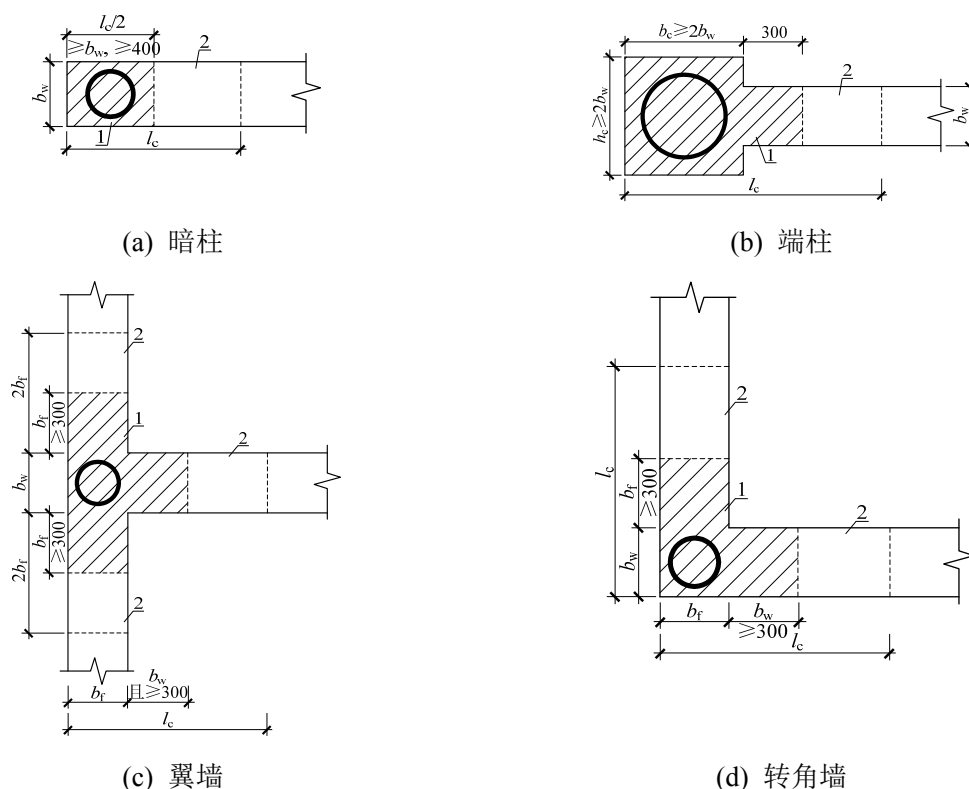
钢管混凝土剪力墙约束边缘构件
